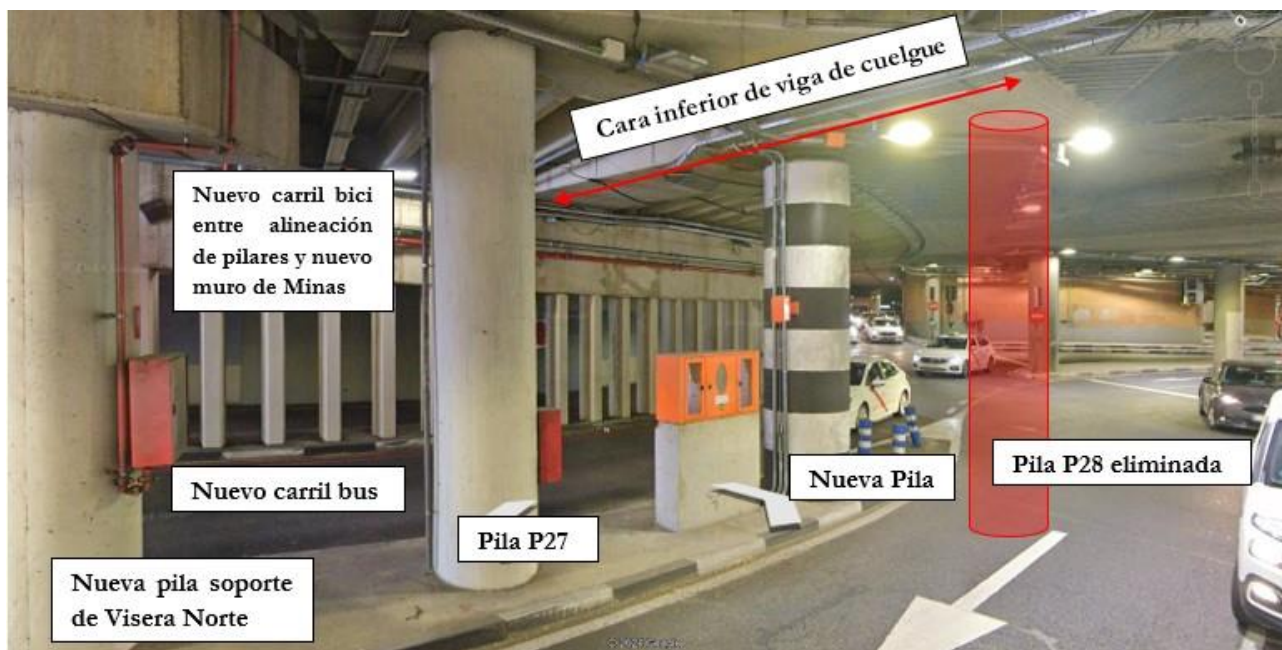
Nuevo conjunto estructural ejecutado para eliminar la pila P28.
